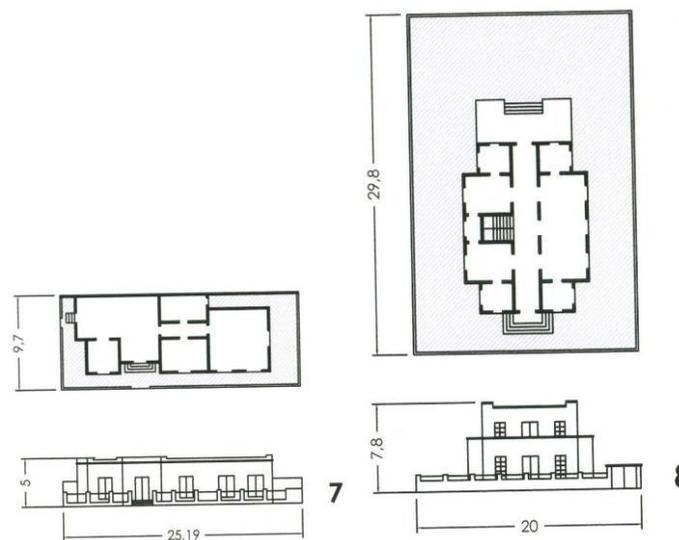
TIPOS DE EDIFICACIÓN AISLADA:
